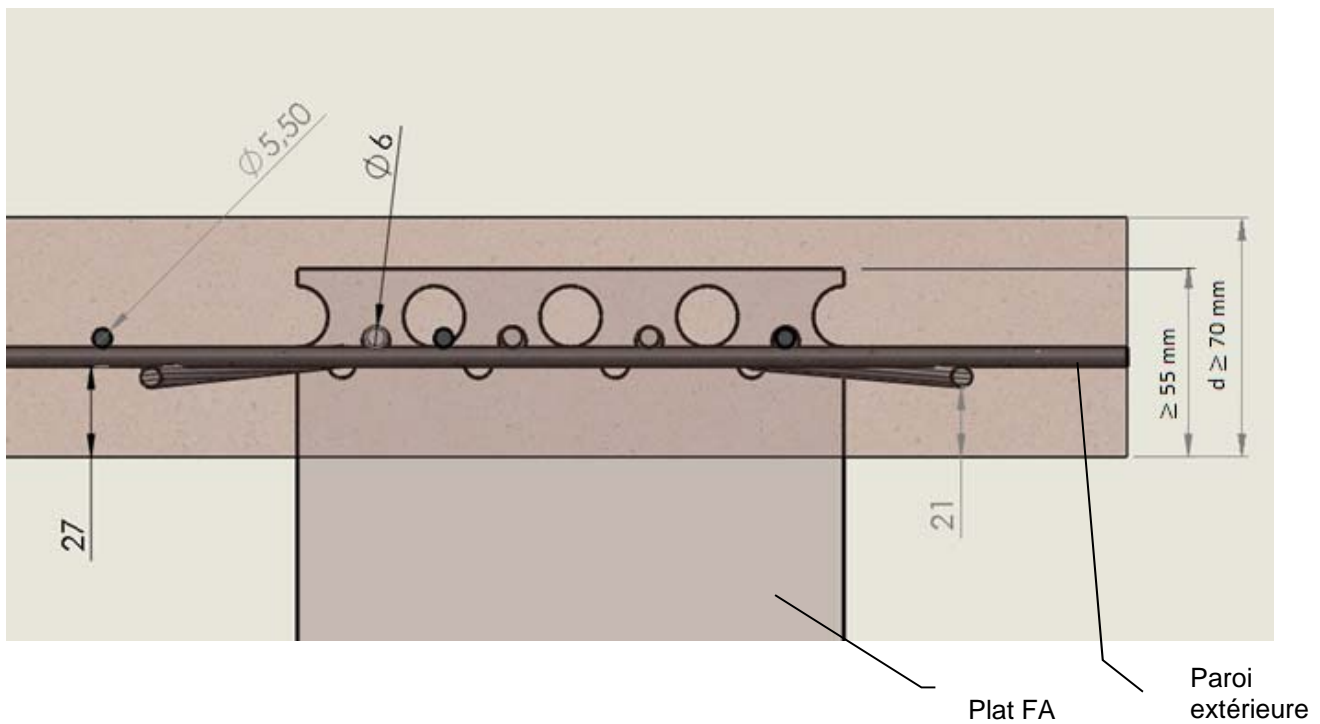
Détails de l'enrobage des armatures (disposition d'un plat)
